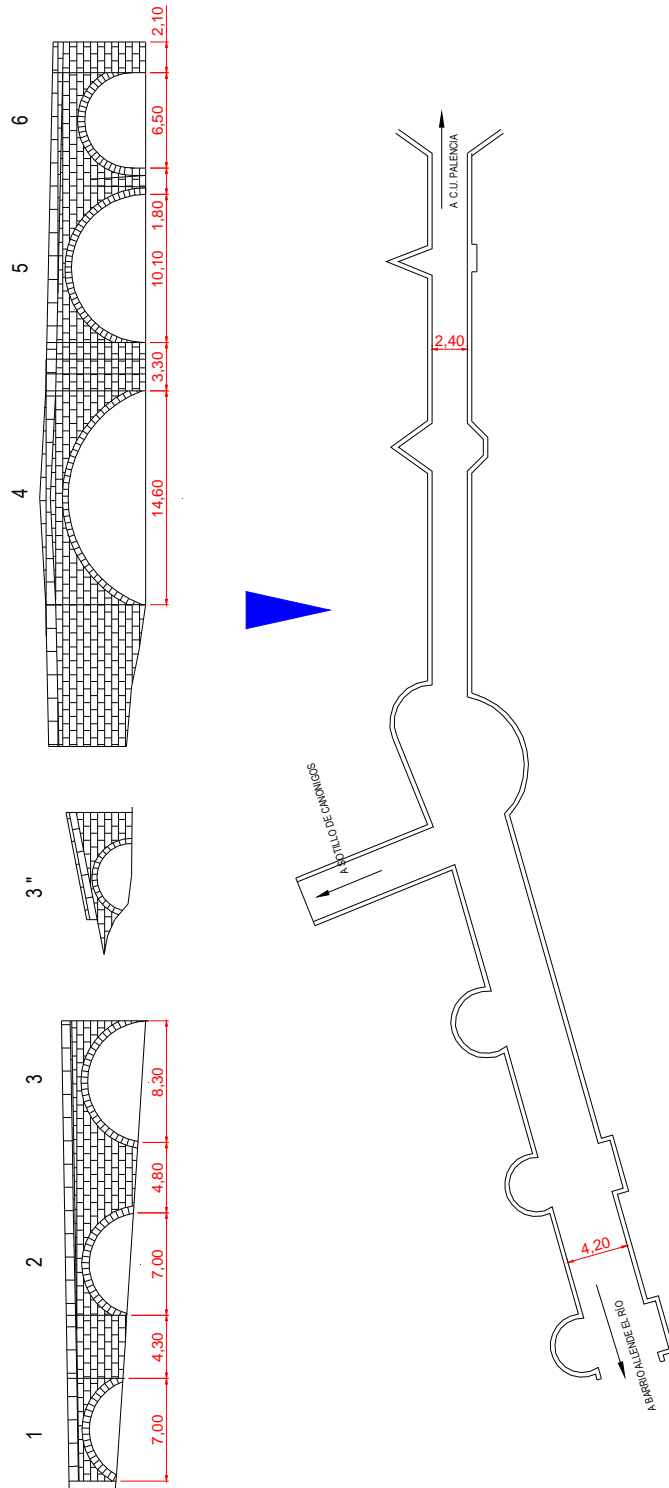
Dibujo de planta y alzado del puente de Puenteillas.
